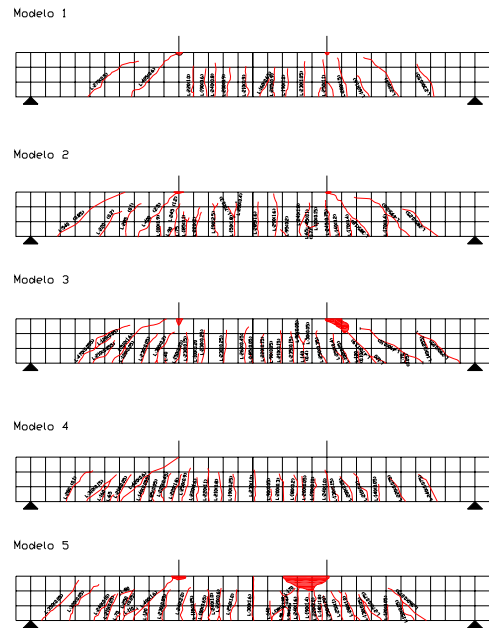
Cuadro de Fisuras relevadas para cada elemento ensayado
